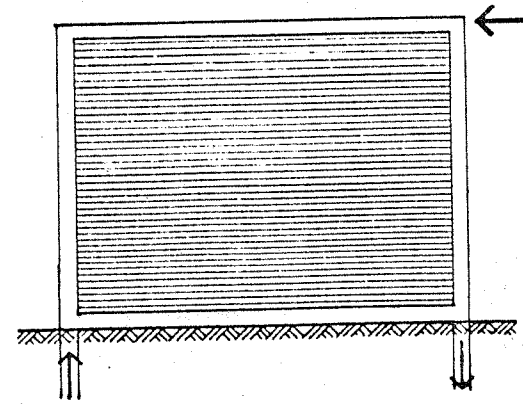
Los encadenados deben anclarse en el cimiento
